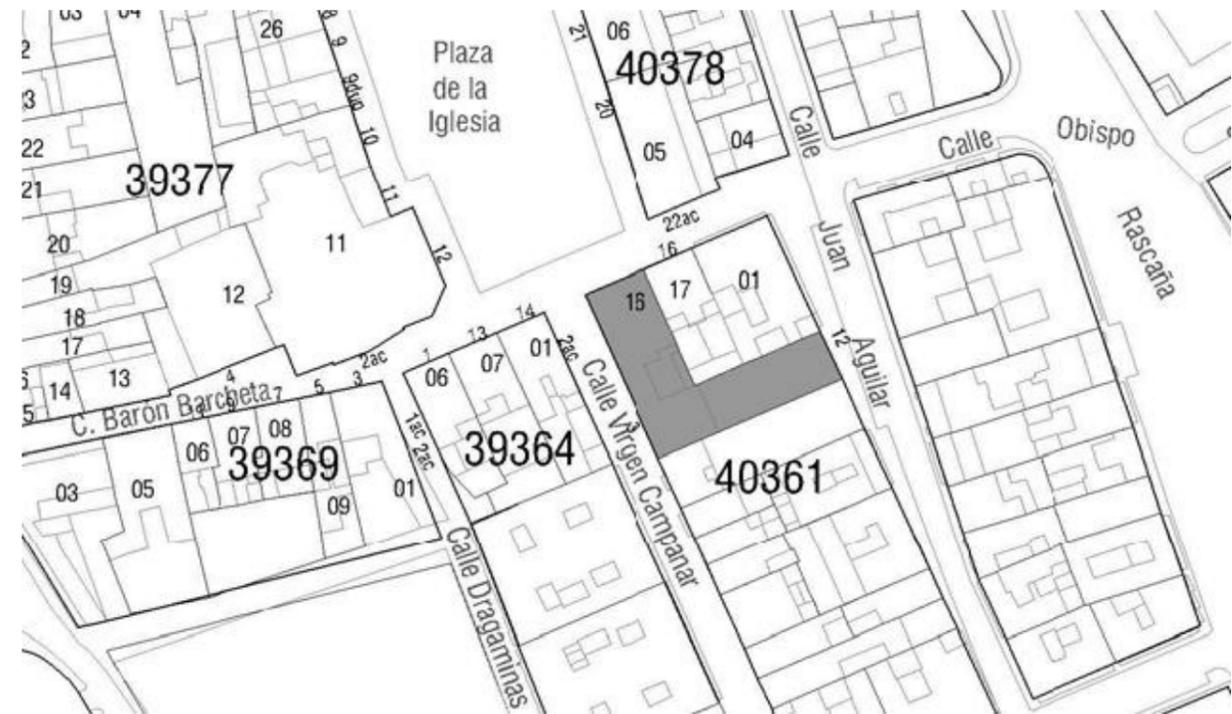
Plano de Emplazamiento extraído del Plan Especial del Entorno PEP-EBIC-02
